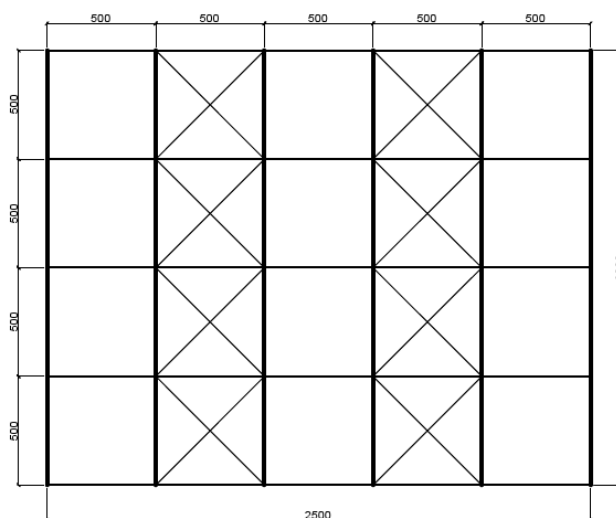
Systemskizze der Tragkonstruktion im Grundriss
